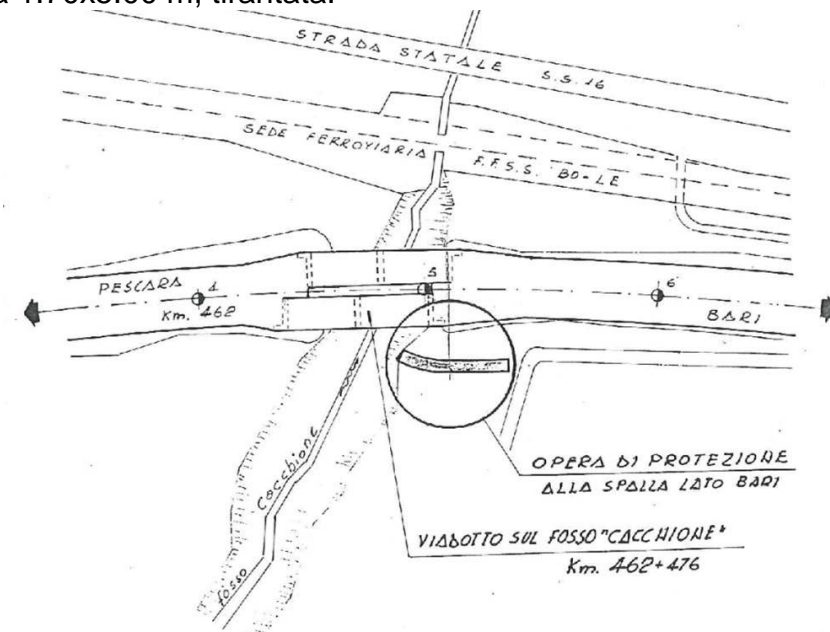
Posizione paratia di pali a protezione delle spalle lato Bari
